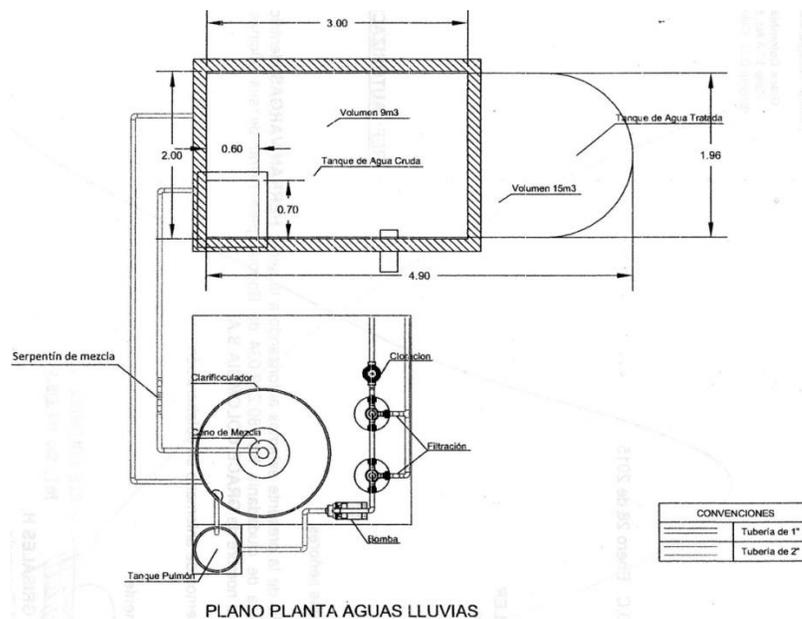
Plano de la planta de tratamiento de aguas lluvias.
